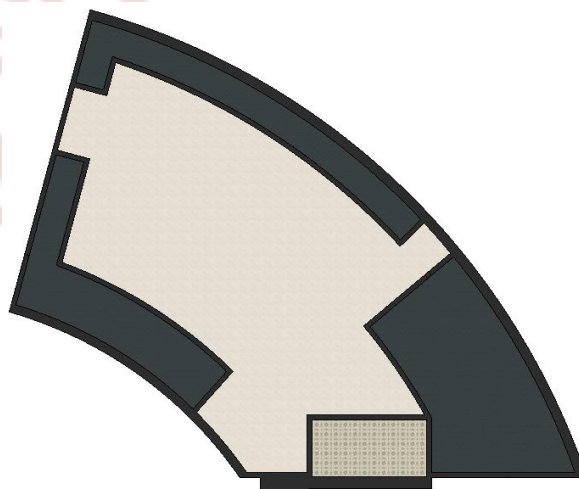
Alternatif 2 Rencana Lantai *Lobby
